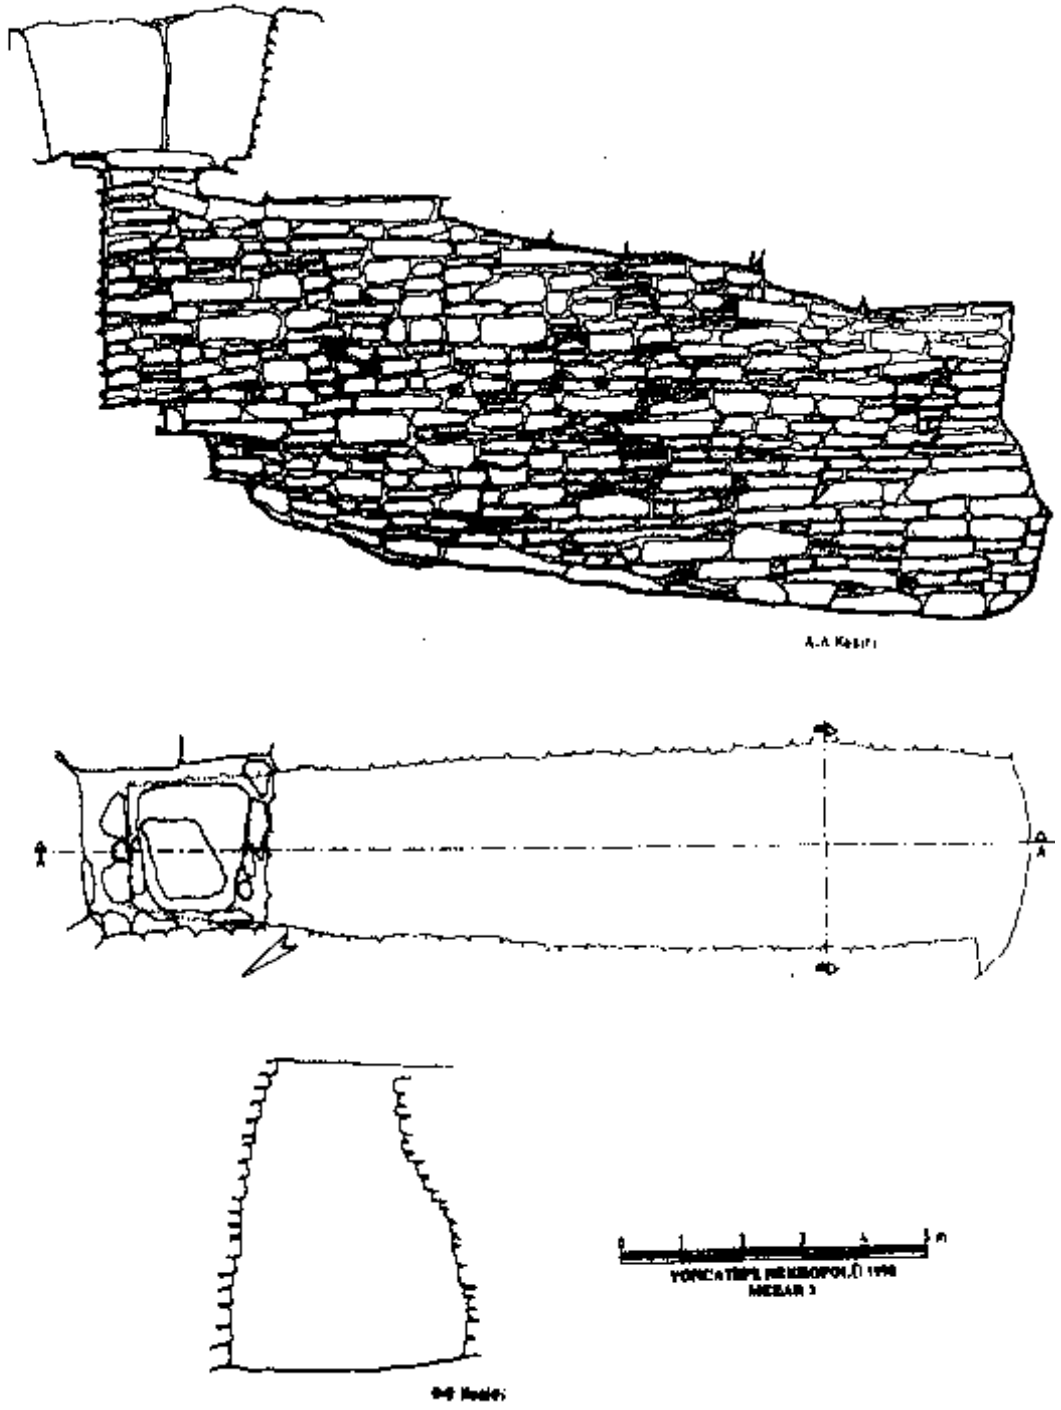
Mezar 2 plan ve kesiti [36].
